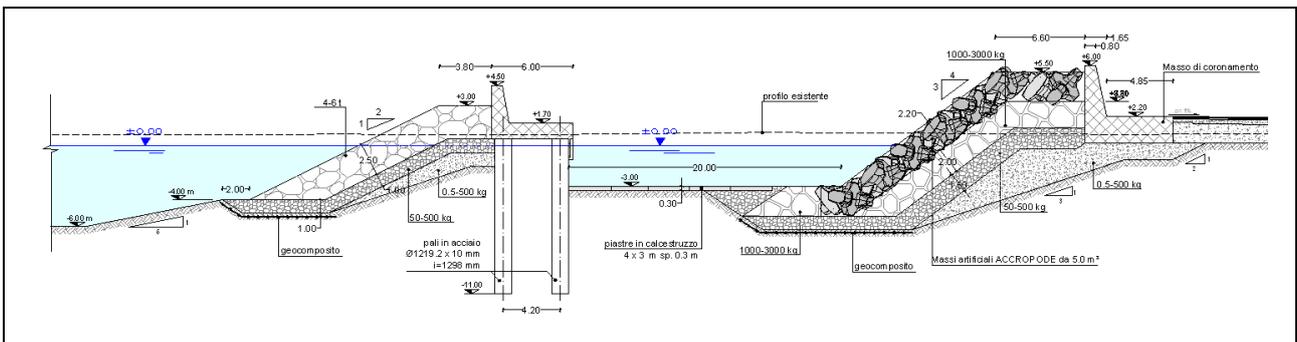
Sezione tipica della foce del Torrente Canneto (sezione B-B)
